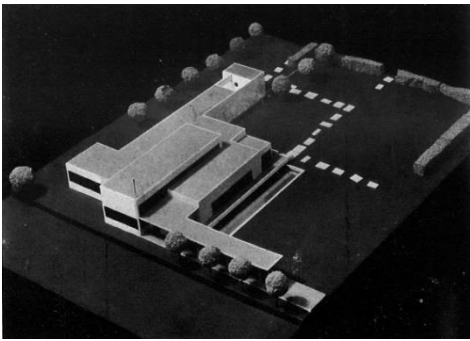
Zonguldak, Kozlu, Mevzi İmar Planı
